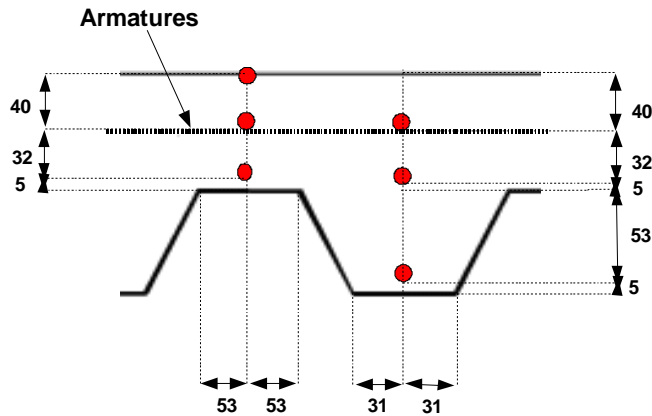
Section droite typique de la dalle mixte montrant les positions des thermocouples
